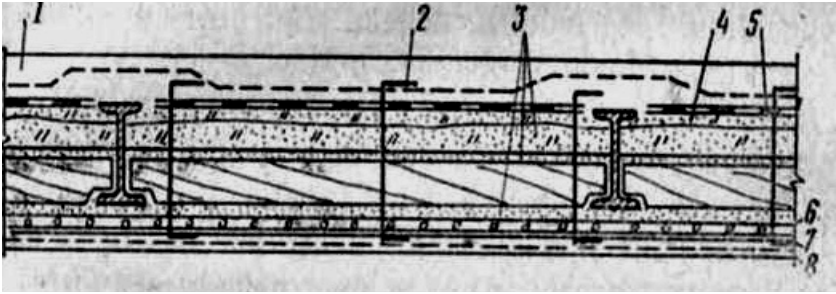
Підсилення монолітного перекриття по зберігаючому міжбалочному заповненню: 1 - залізобетонна плита; 2 - Г-подібні анкери-підвіски; 3 - існуюче міжбалочне заповнення; 4 - додатковий шар засипки; 5 - шар руберойду; 6 - арматурний каркас; 7 - штукатурна сітка; 8 - штукатурка
